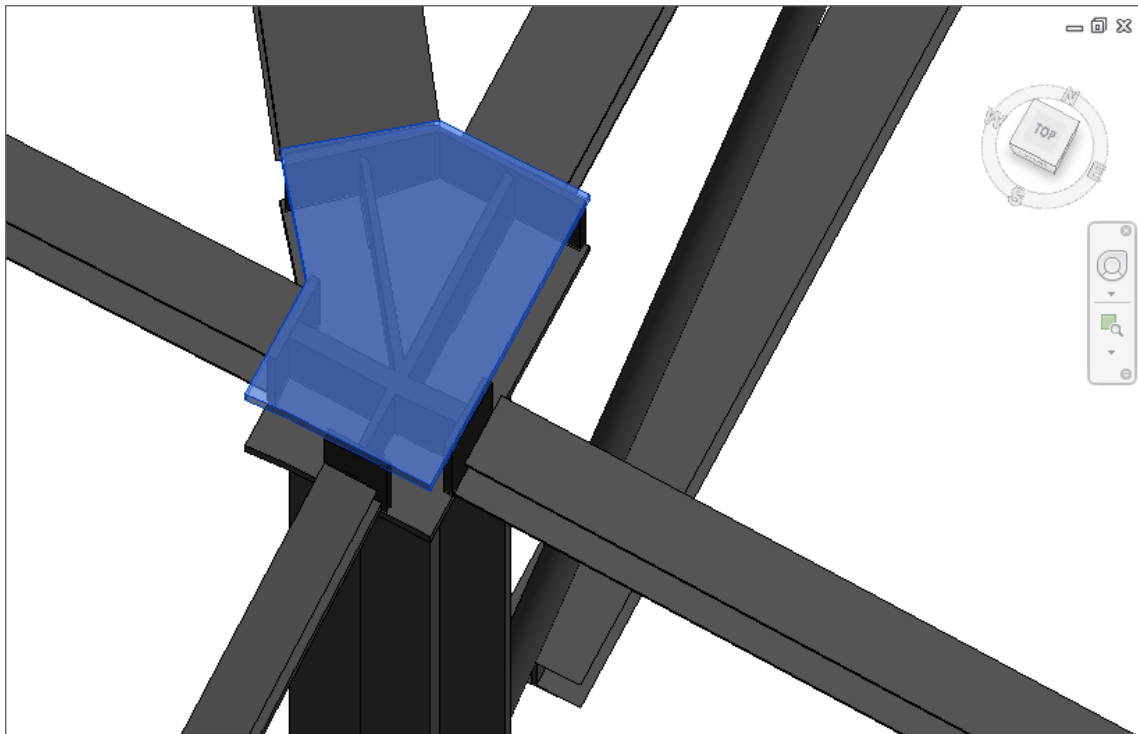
1ª Visualização tridimensional da ligação entre 5 vigas e um pilar
